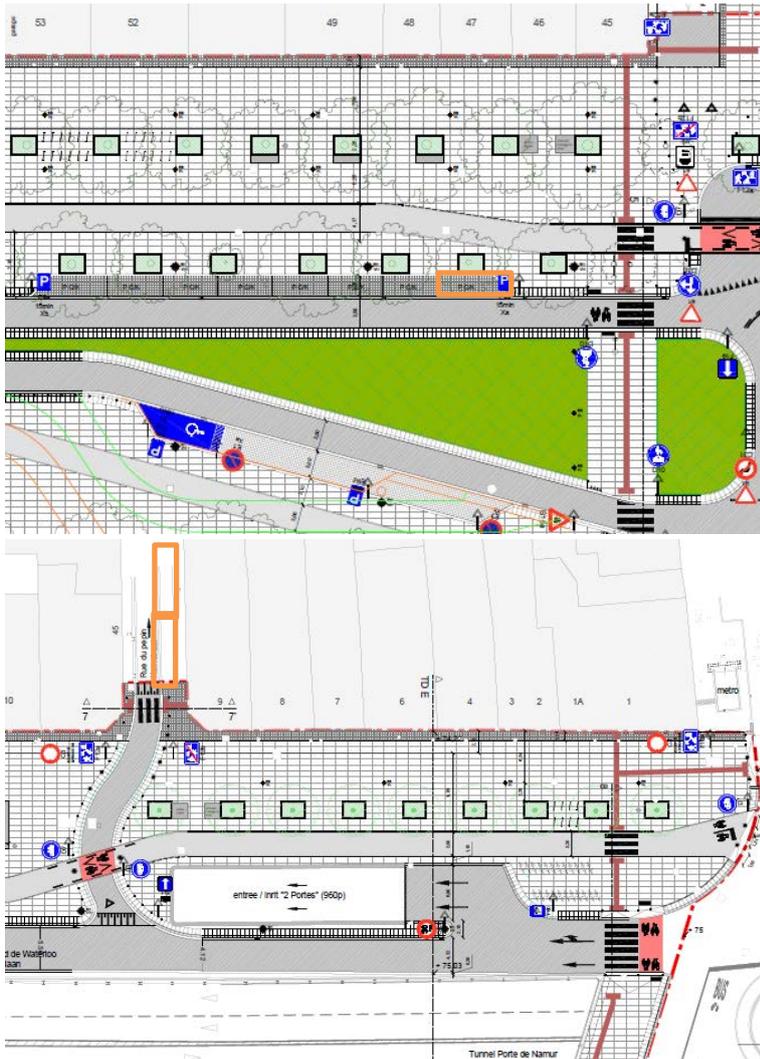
Localisation des 3 places de stationnement "voiturier" en orange (Plans : Polo)
